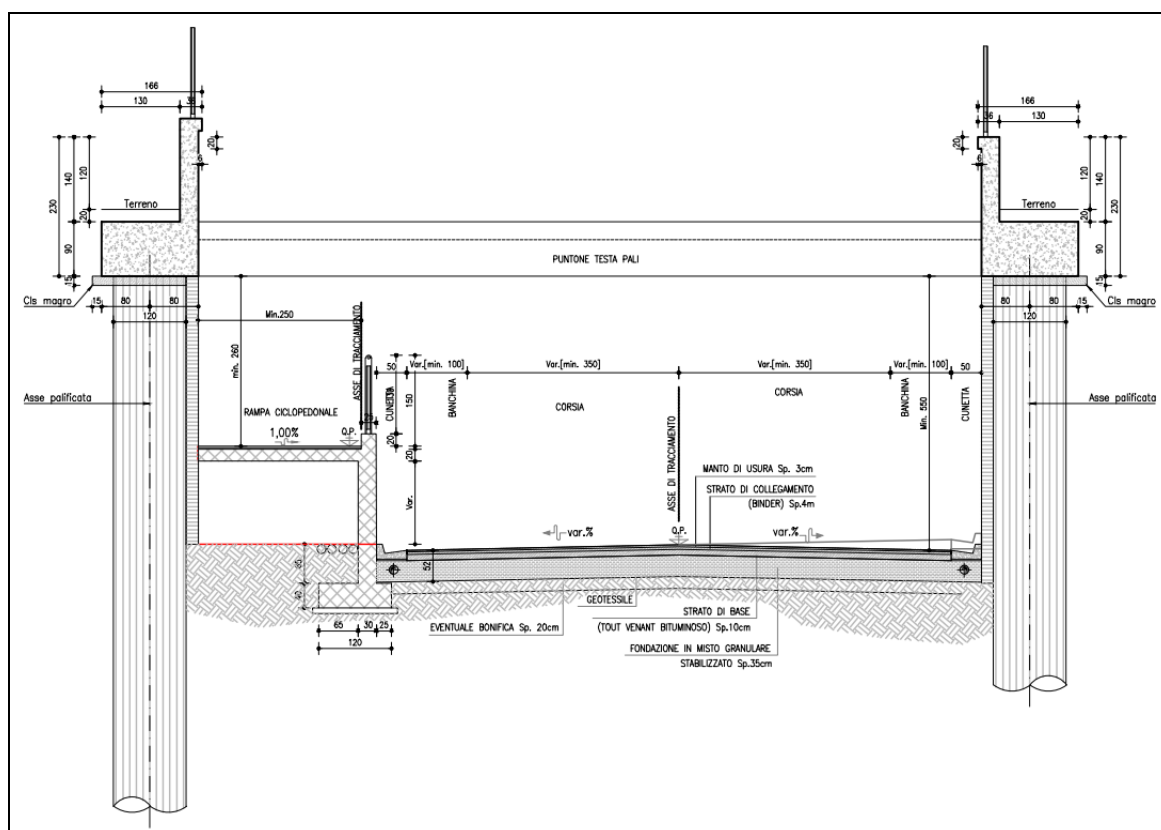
Sezione tipo asse principale con pista ciclopedonale palificata con puntone testa pali (sezione a cielo aperto)
